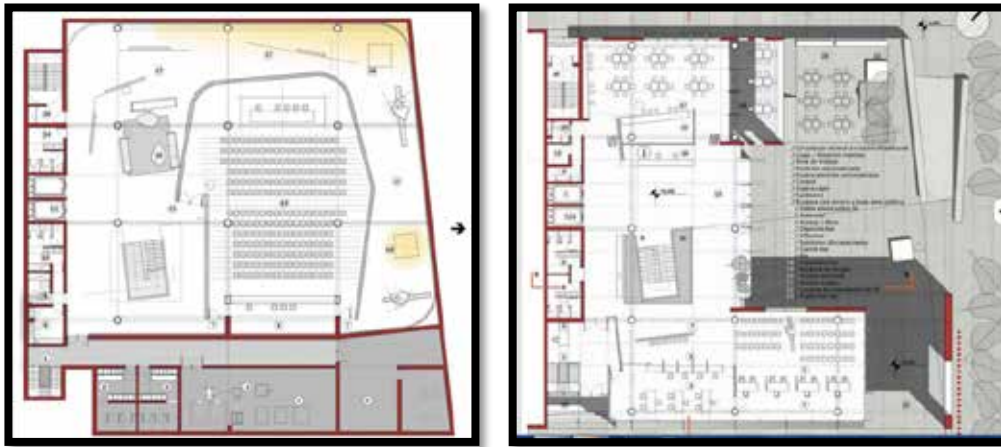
Planta sótano (Izquierda) Panta baja (Derecha) Centro de Gestión y participación en Lugano.
